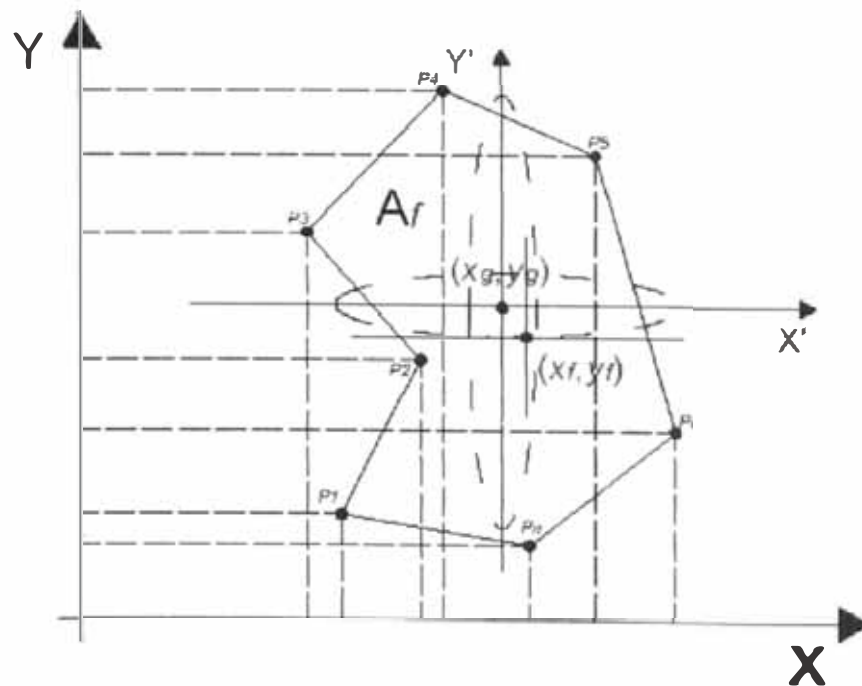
Forma general de una planta considerada para el cálculo del parámetro 6 (configuración en planta del edificio).
